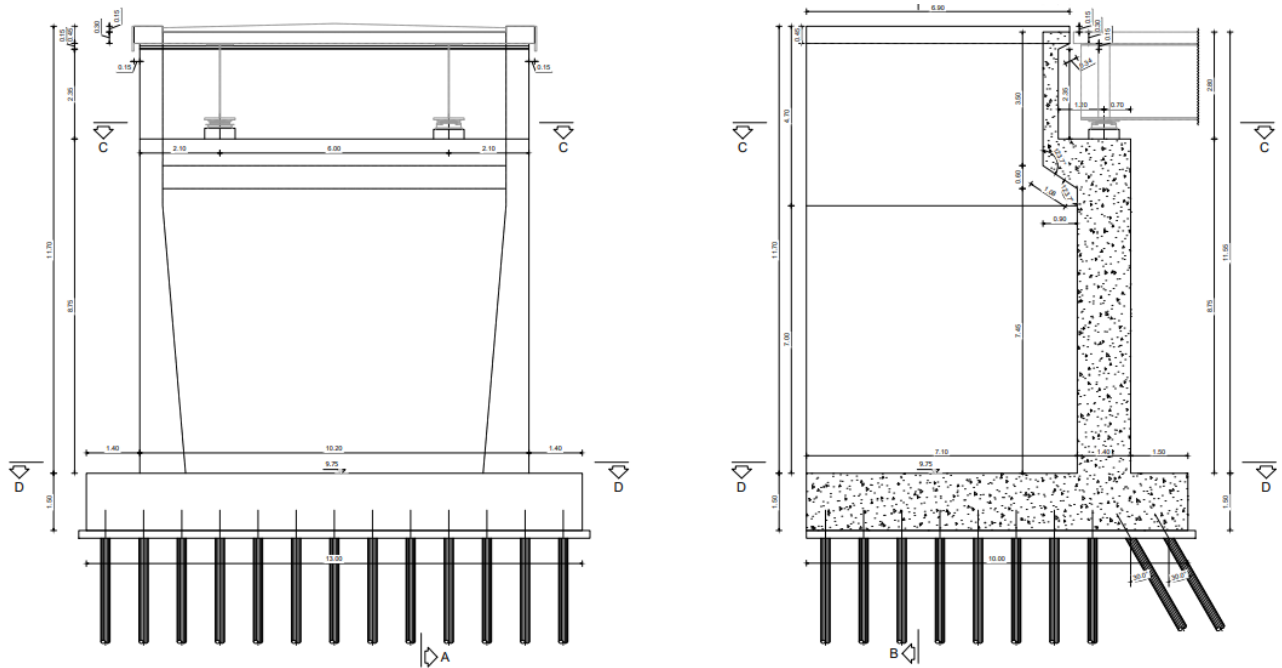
Prospetto e Sezione spalla "SP1" lato Rotatoria 1
